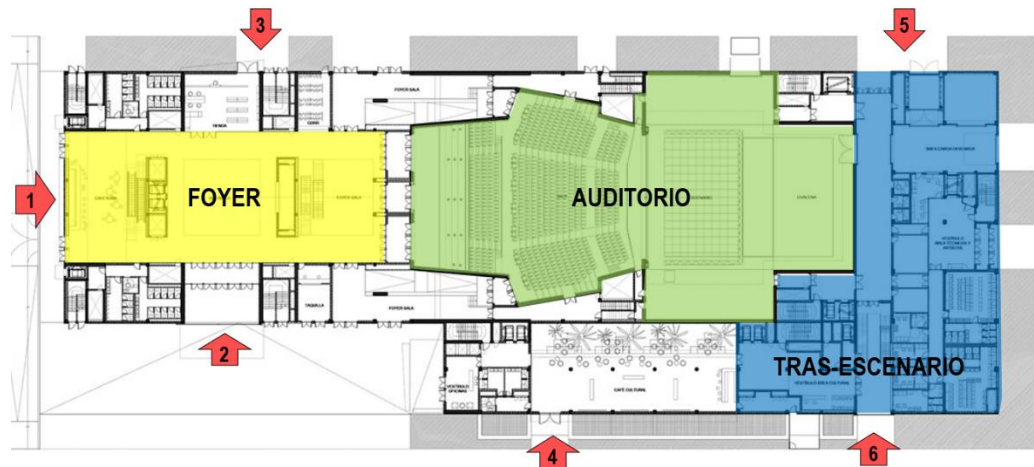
Esquema de ingresos y espacios, elaborado a partir de imagen del proyecto. Planta primer nivel - CITE Sevilla.
